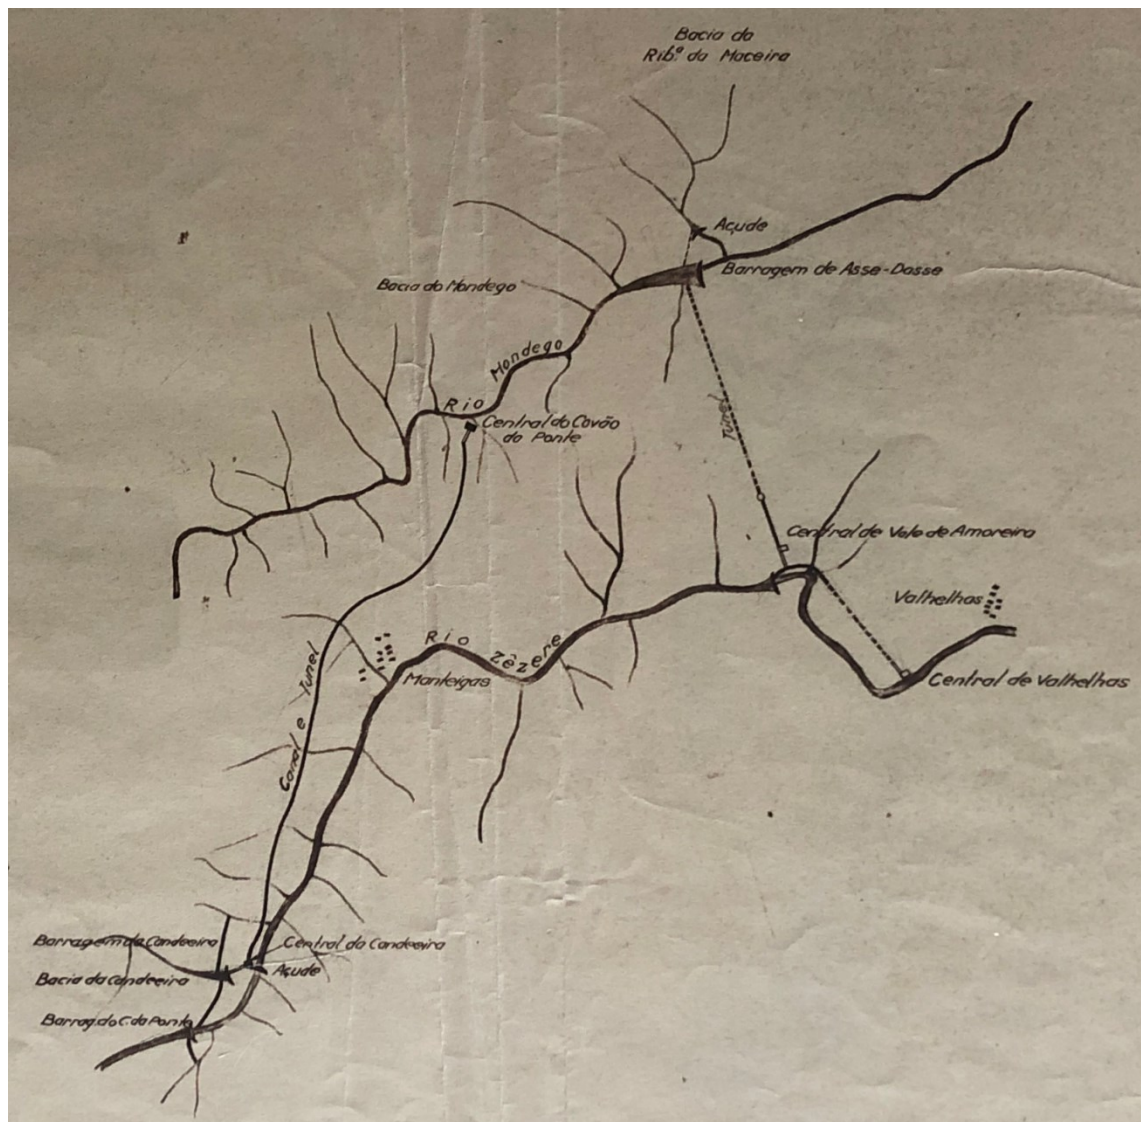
Desenho Nº.1.593 Planta do aproveitamento do Alto Zêzere e Alto Mondego.
